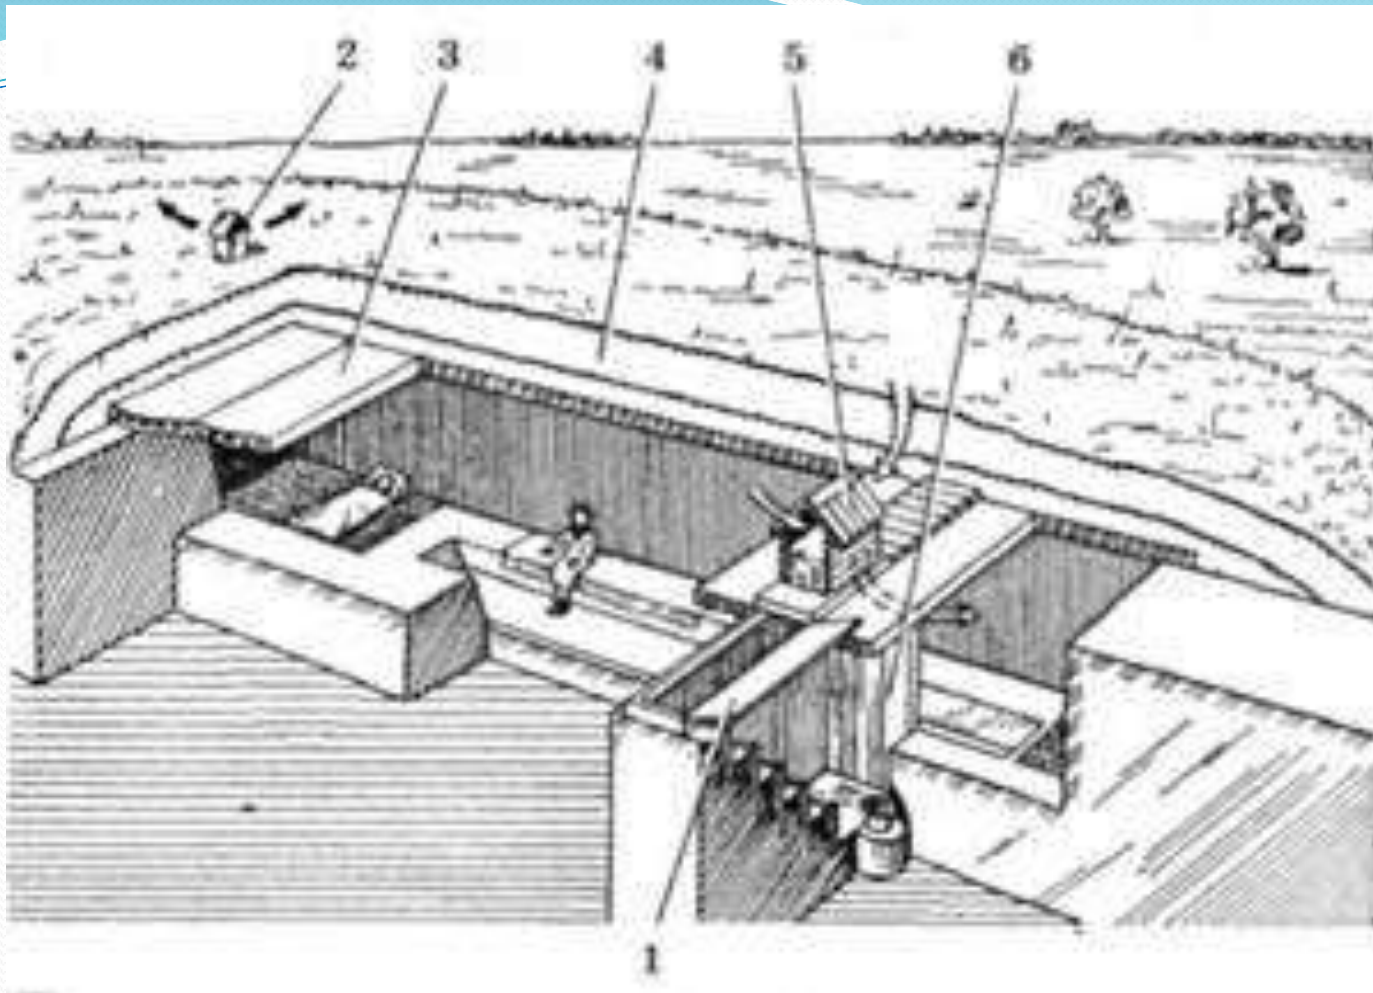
Протирадіаційне укриття з перекриттям із залізобетонних плит:
